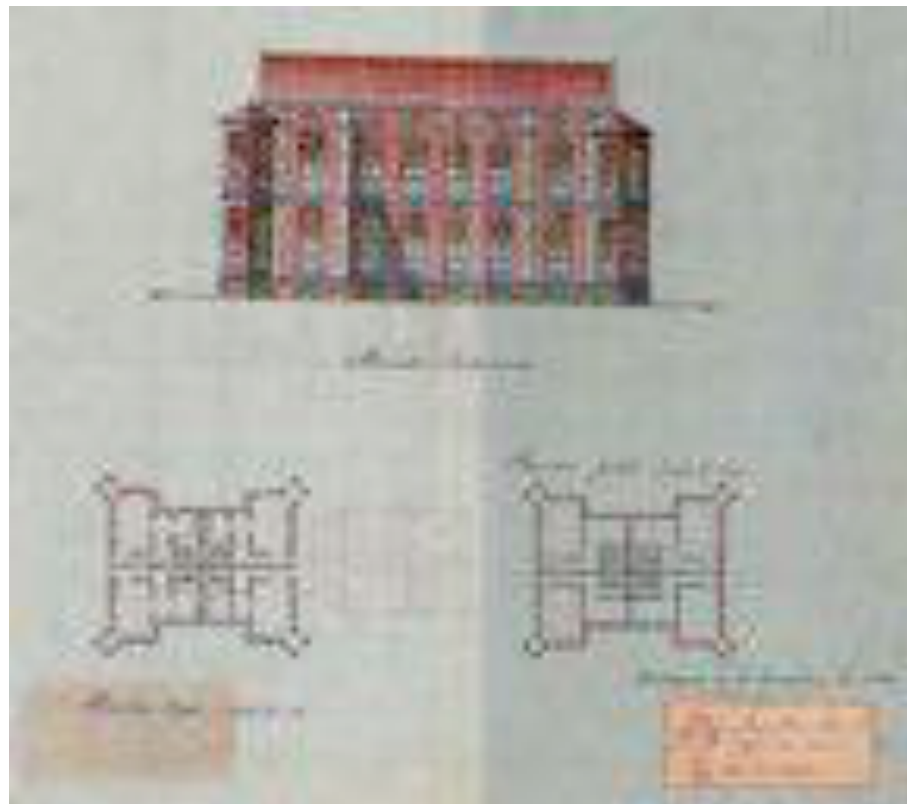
Plano de la Casa aislada nº23 en la manzana 68. 31 de diciembre de 1902. AMC.
